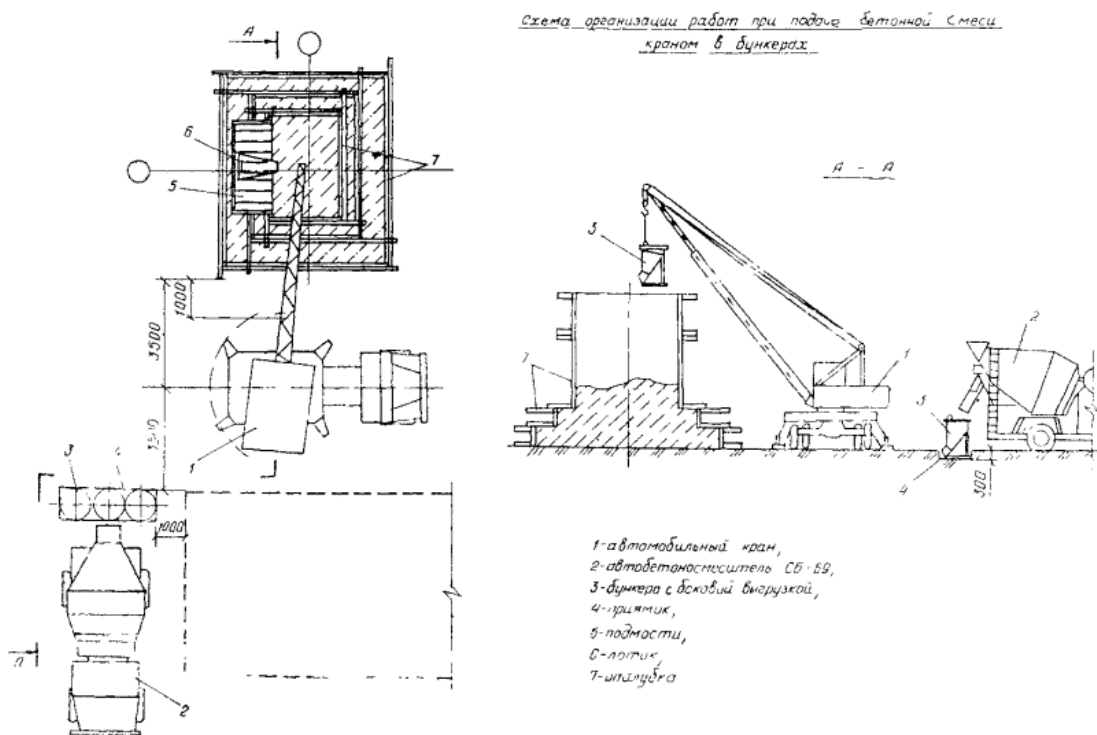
Возведение монолитных железобетонных фундаментов под колонны
